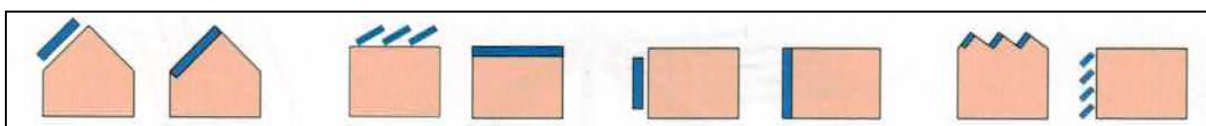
Příklad konstrukcí fotovoltaických panelů [1]
